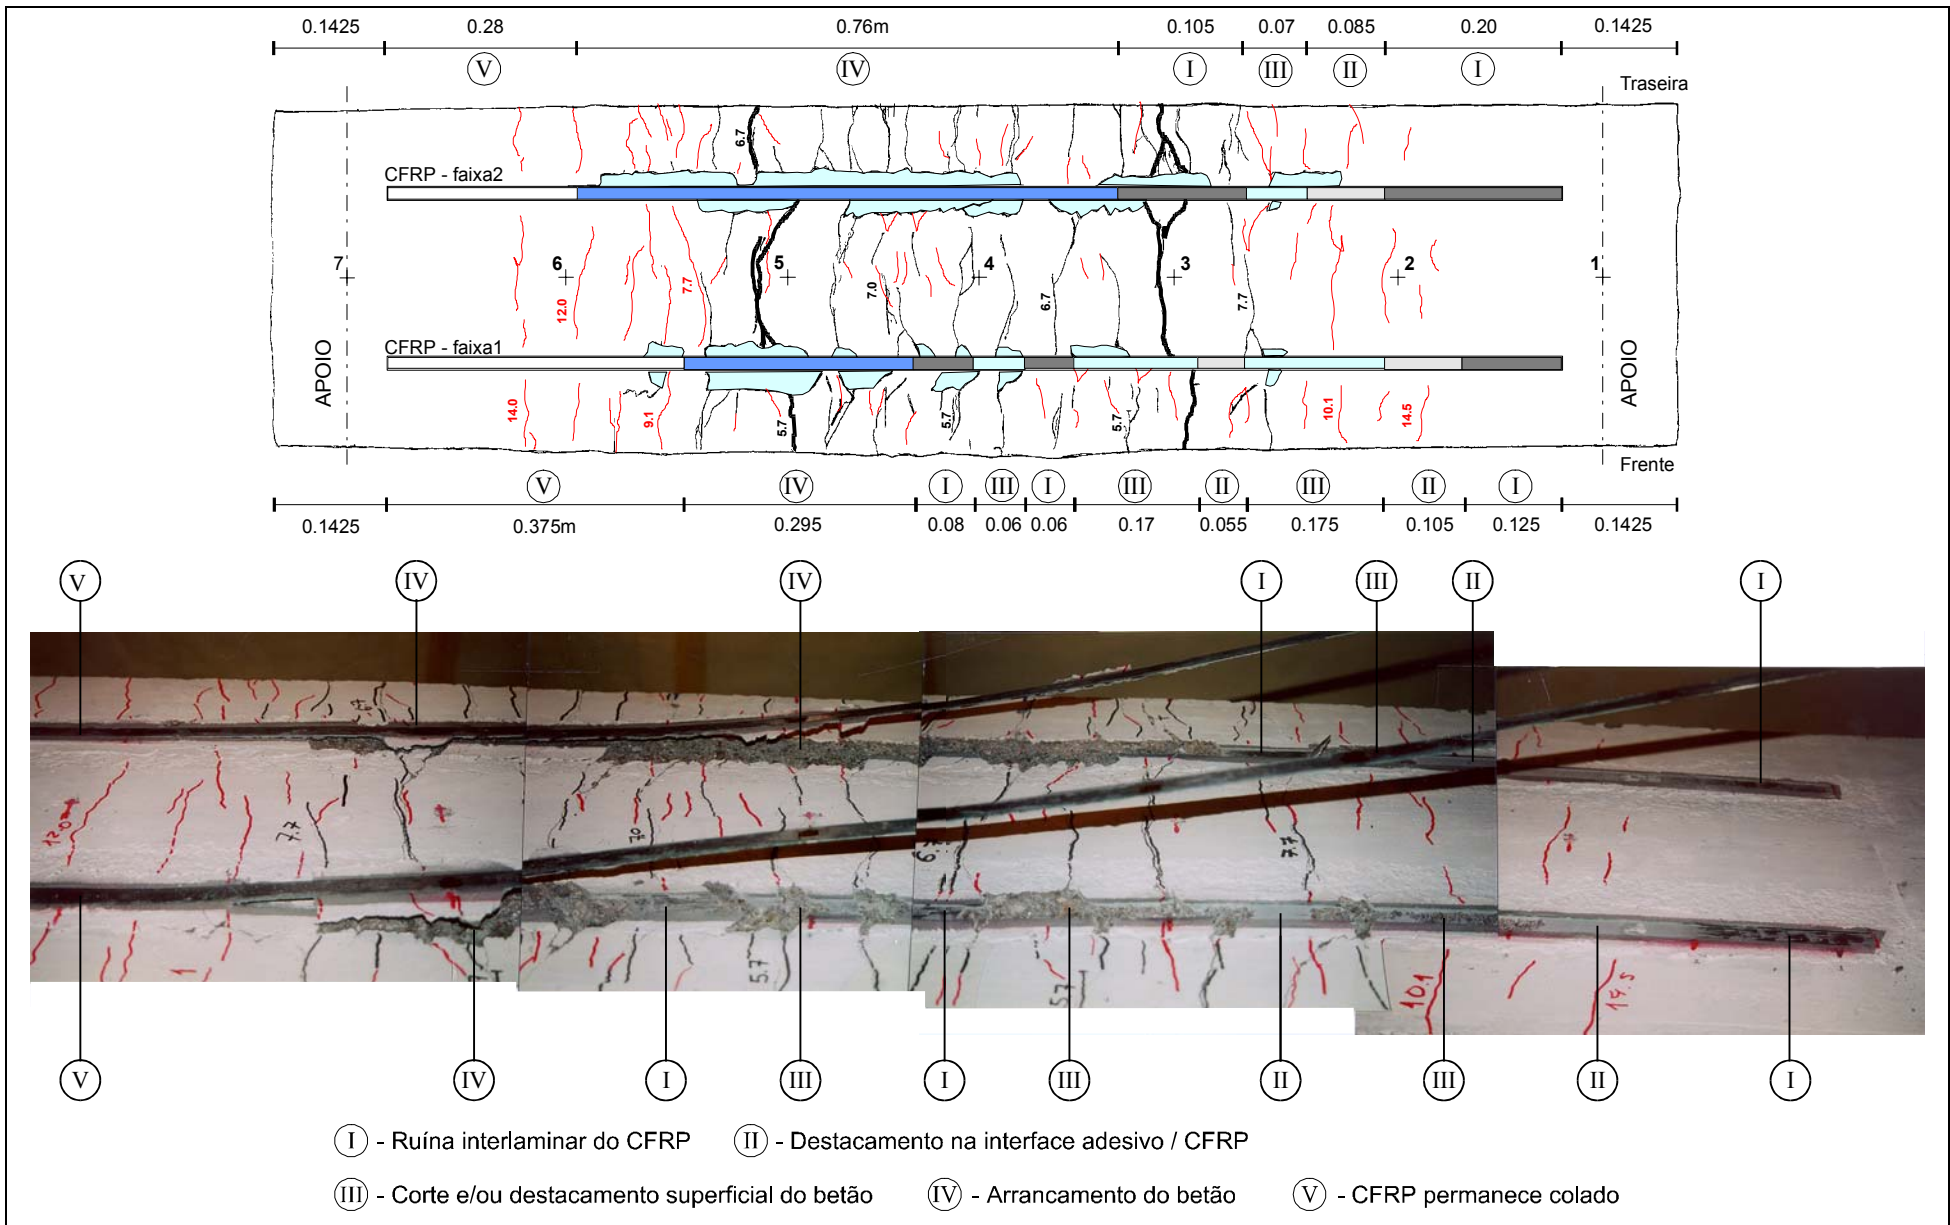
Ruína do laminado de CFRP na laje LC2S (planta e pormenor).
